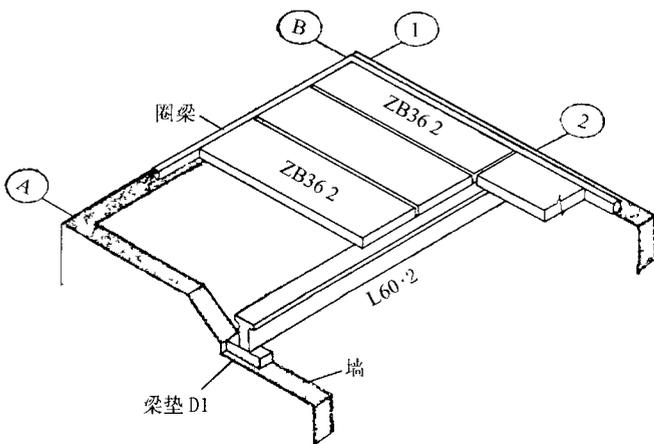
预制装配式钢筋混凝土楼盖结构布置示意图
